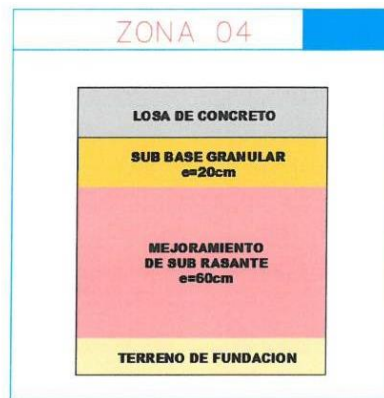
Sección recomendada de pavimento ZONA 04. Fuente: Elaboración Propia.
